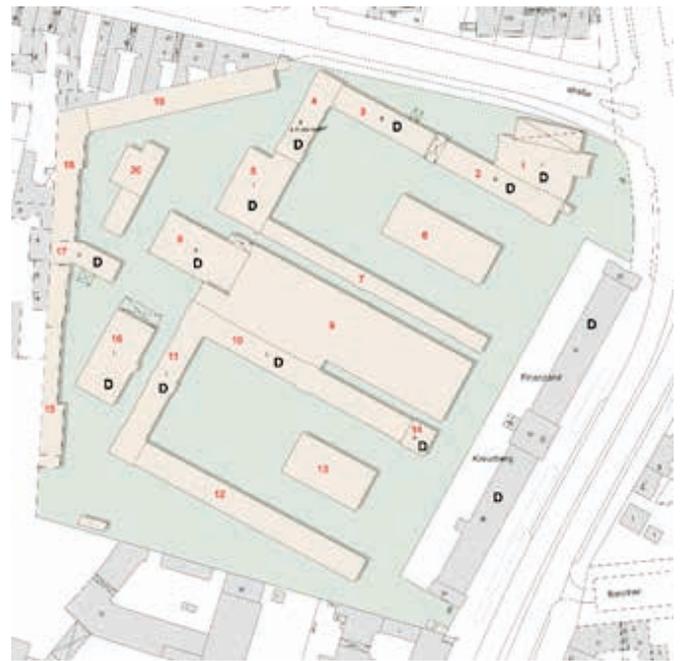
Bestandsgebäude Dragonerareal nummeriert mit Geschosshzahl
